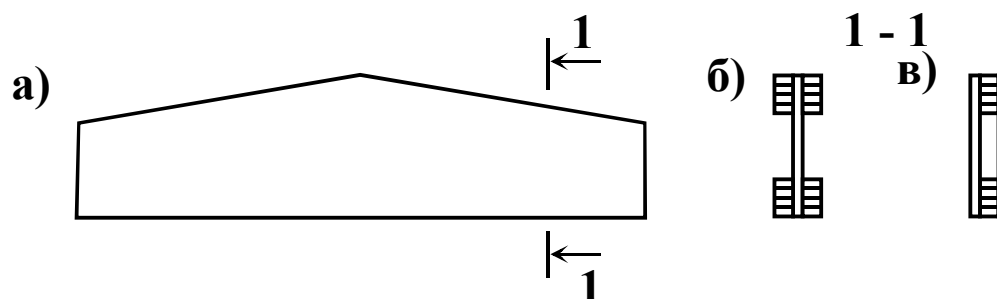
Схема клеефанерной балки (а) и ее сечения б – двутавровое; в – коробчатое
